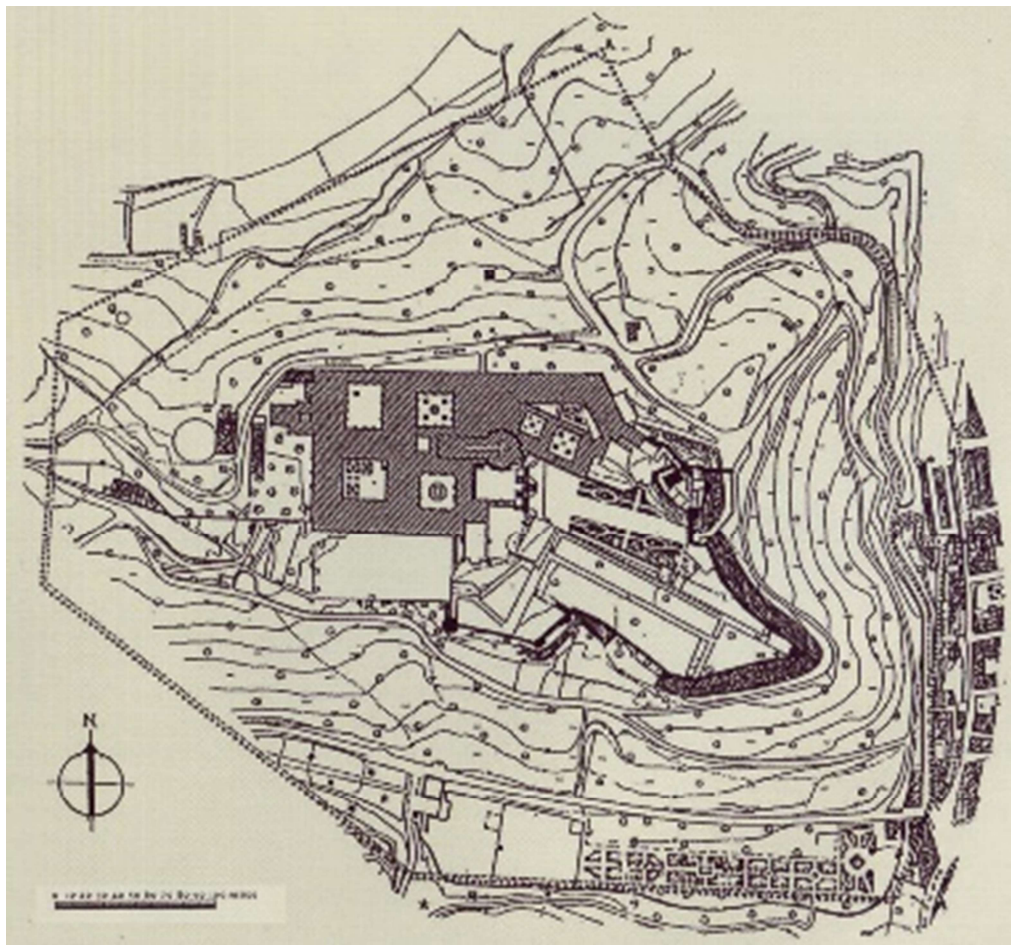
Planta de Localização do Castelo dos Templários (*historiadeportugal*, 2014)
